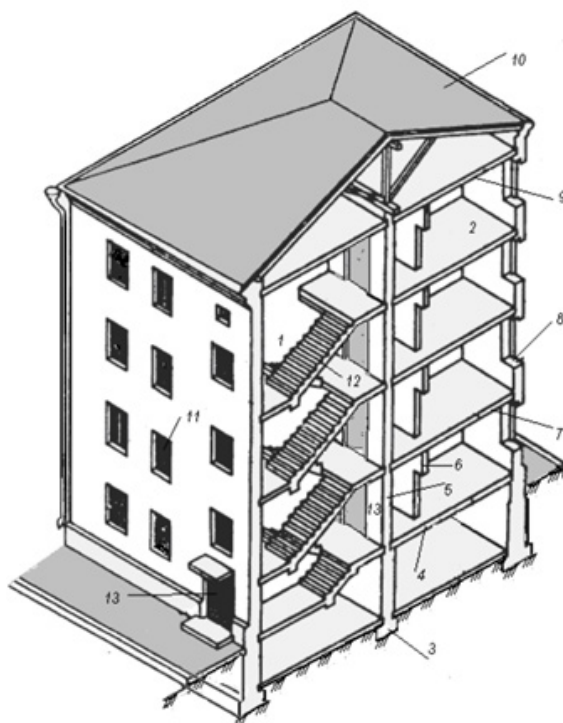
Схематичне зображення будівельних конструкцій багатоквартирного будинку
